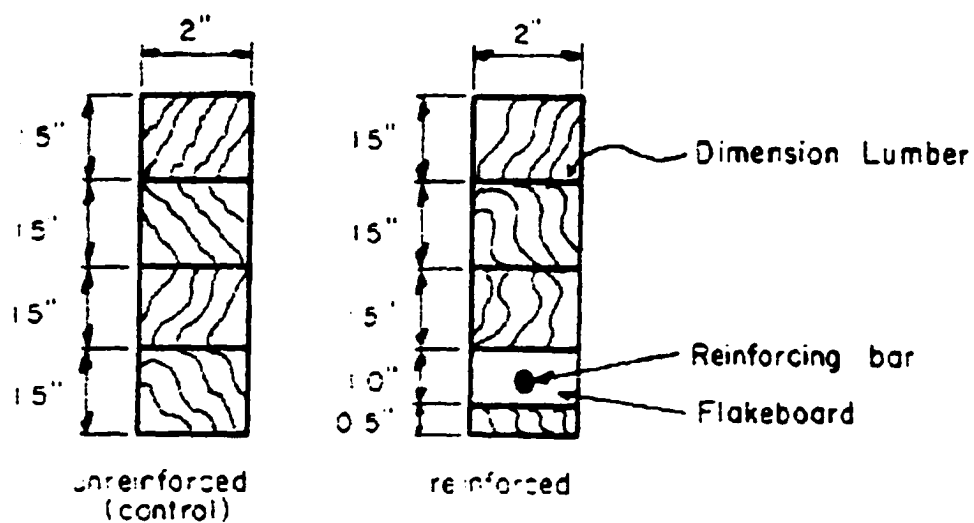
Section typique de poutre renforcée avec une barre d'armature à béton
